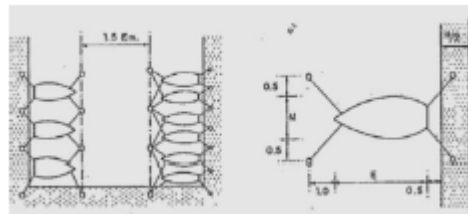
IMAGEN VI. ATRAQUE DE POPA CON AMARRE A PILOTES. PIANC
